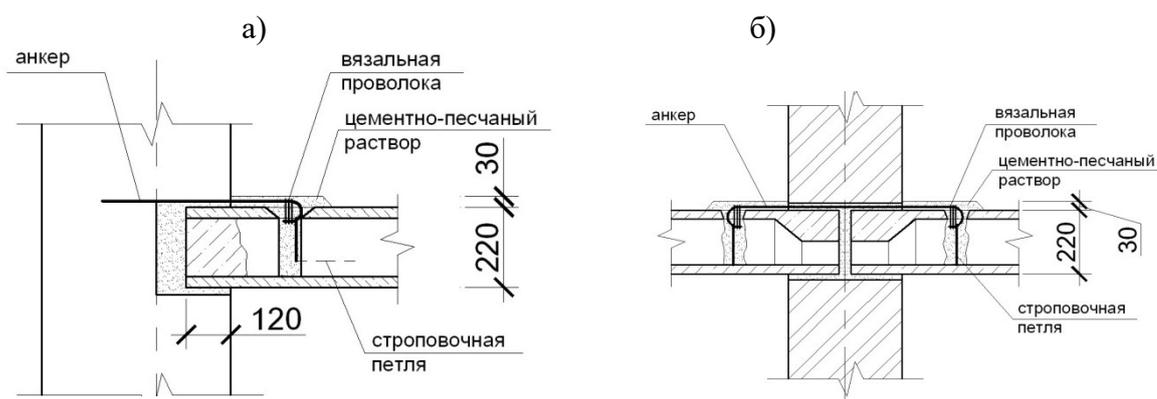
Узлы опирания плит перекрытий: а – на наружную несущую стену; б – на внутреннюю несущую стену.
